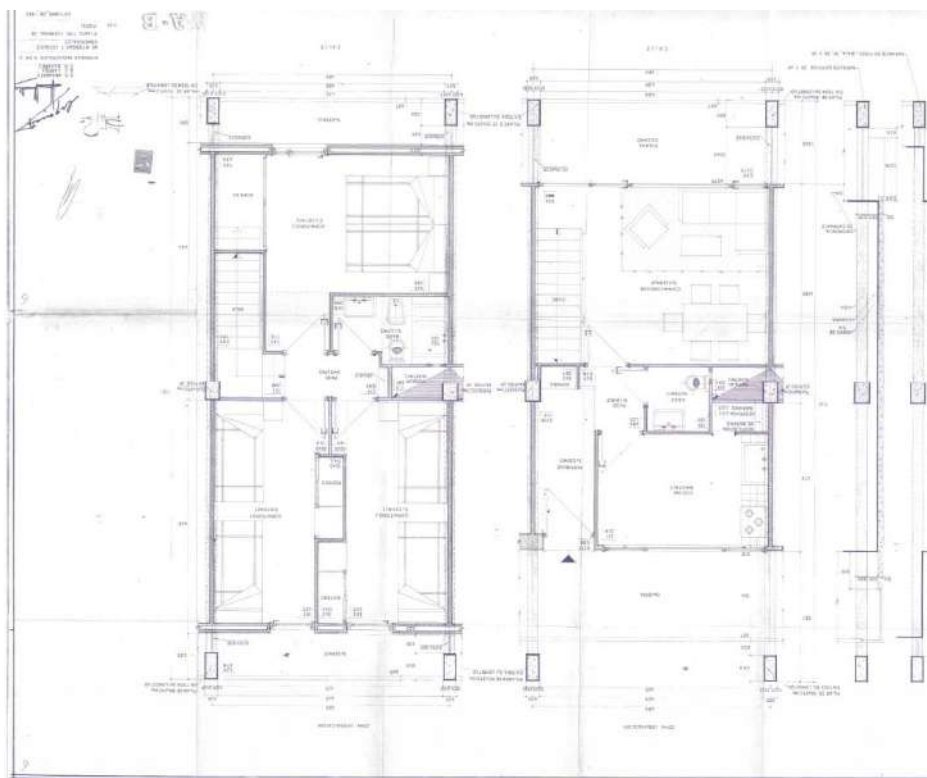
Planta del apartamento dúplex. Fuente: Proyecto para viviendas y locales comerciales, Grupo Pedro Astigarraga. Archivo Municipal de Bilbao, 63-5-313.
